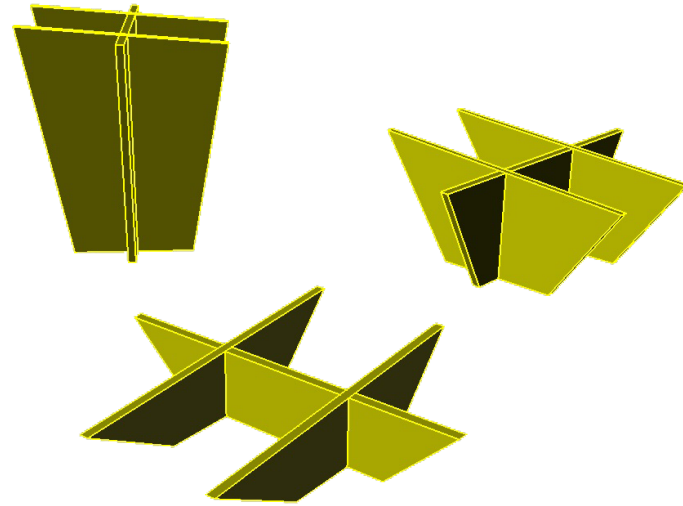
> Cantidad de tableros para elaborar columnas y conectores
